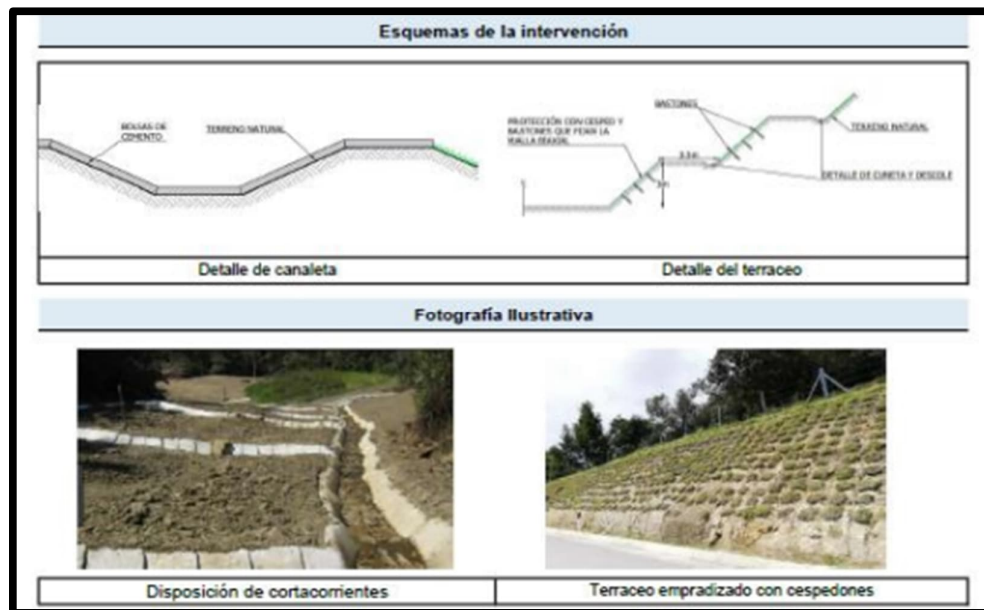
Infraestructura Verde de Estabilización. Cunetas Protegidas mediante Bolsas de Cemento
